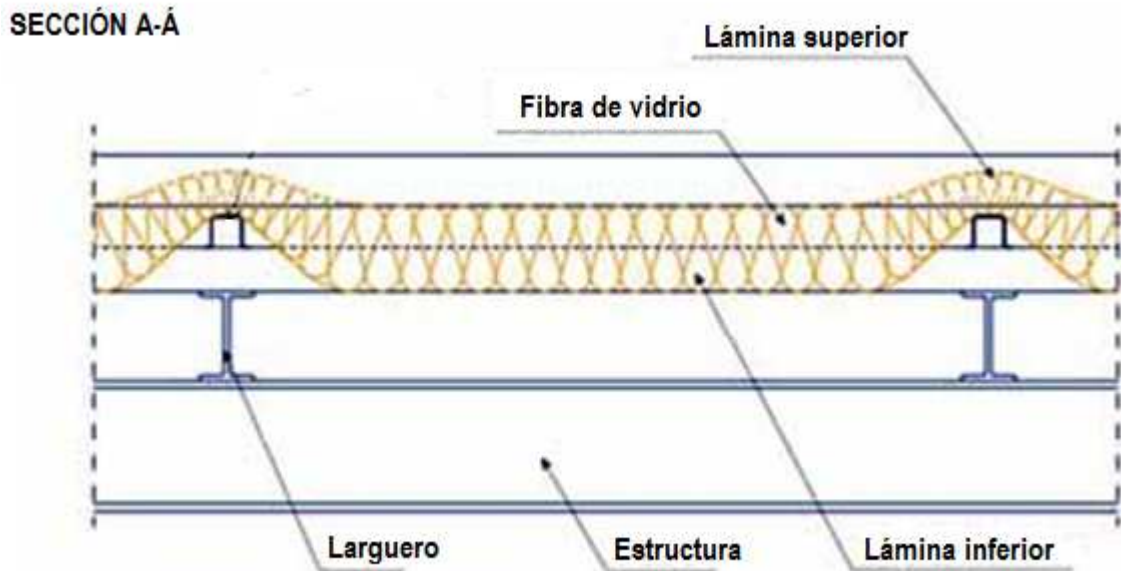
Detalle de puesta en obra de un panel sándwich.
